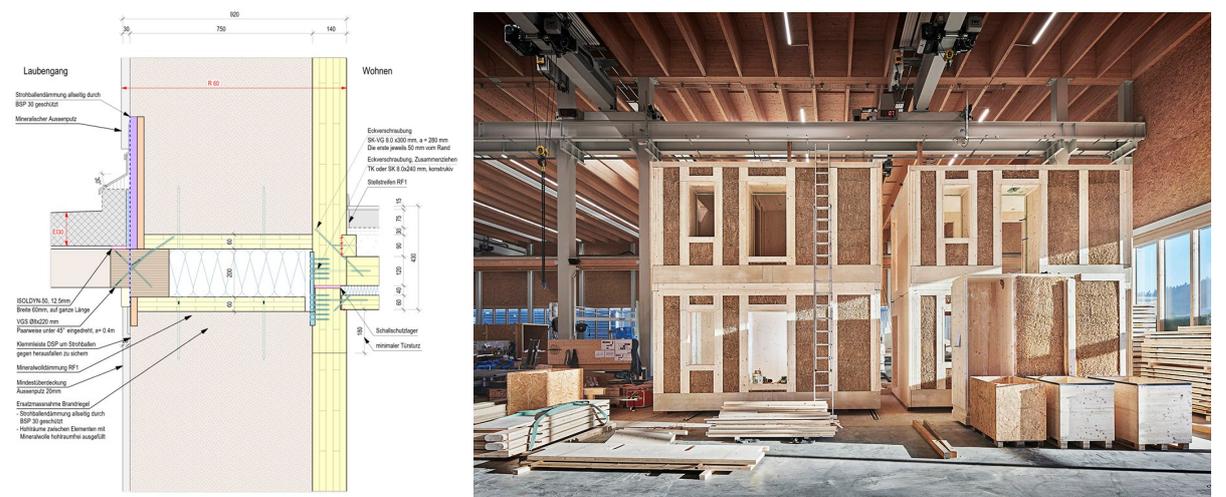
Aussenwandkonstruktion als Kombination von Holzrahmen- und Brettsperrholzbauweise (Strohdämmung)
